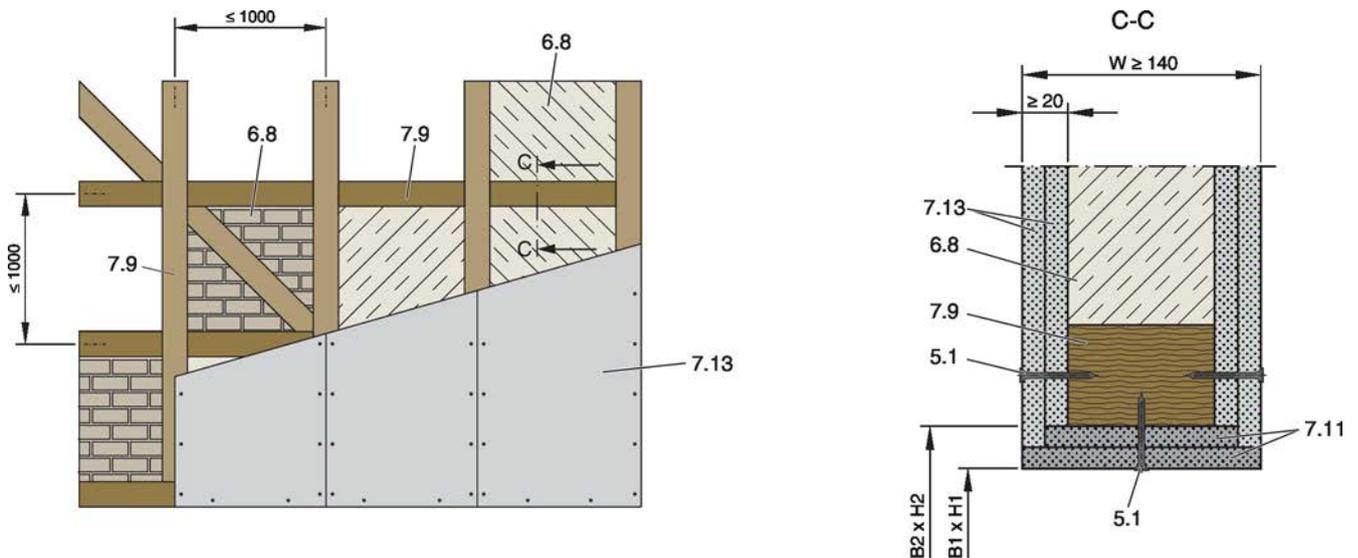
Leichtbauwand mit Holzfachwerk und beidseitiger Beplankung
